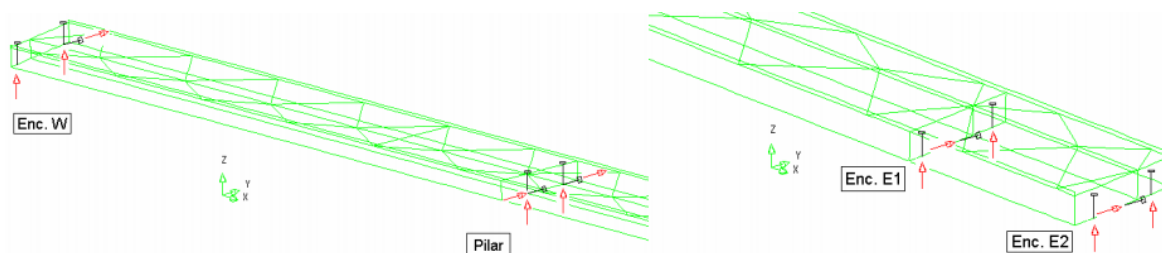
Condições de apoio definitivas nos encontros e pilar (Pimentel, M. *et al* 2005).
